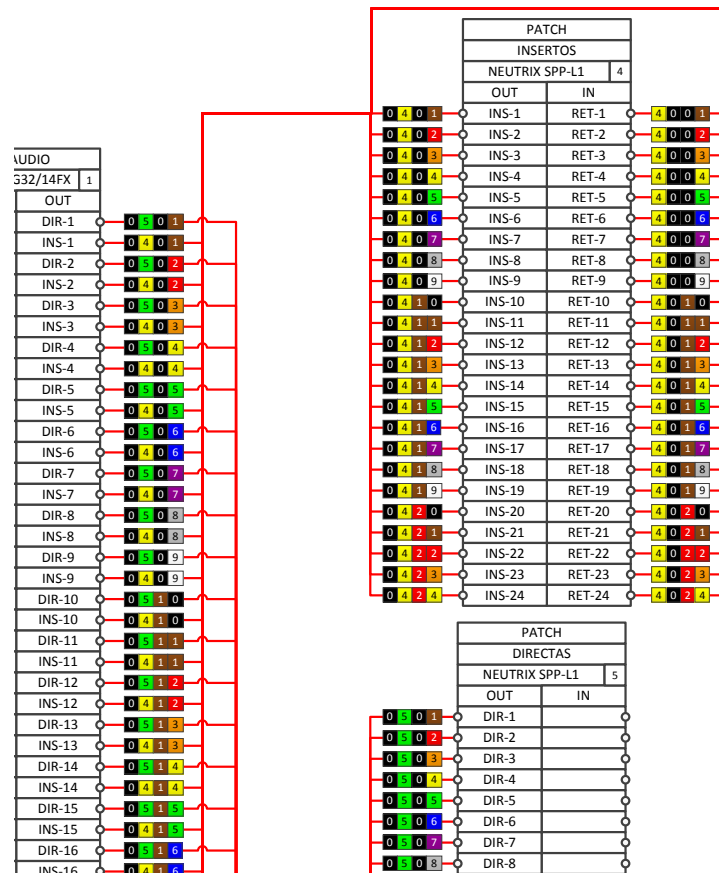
PLANIMETRÍA DE AUDIO- PATCH 4 y PATCH 5
